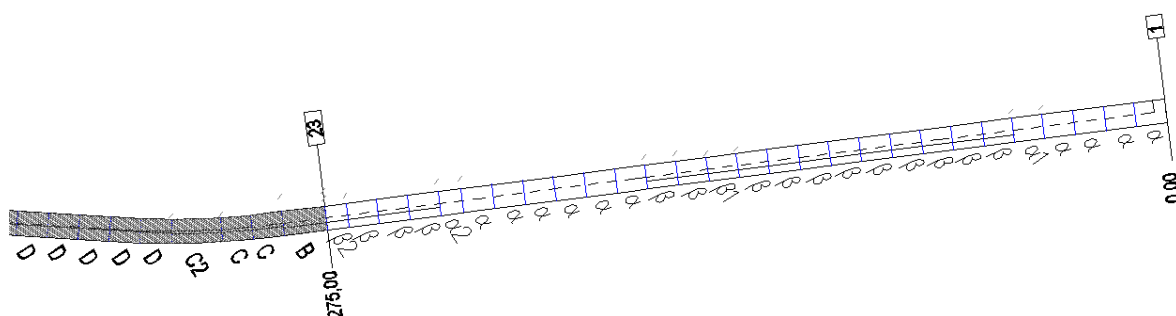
Planimetria con individuazione della sezione terminale e finale e dei blocchi tipologici.
